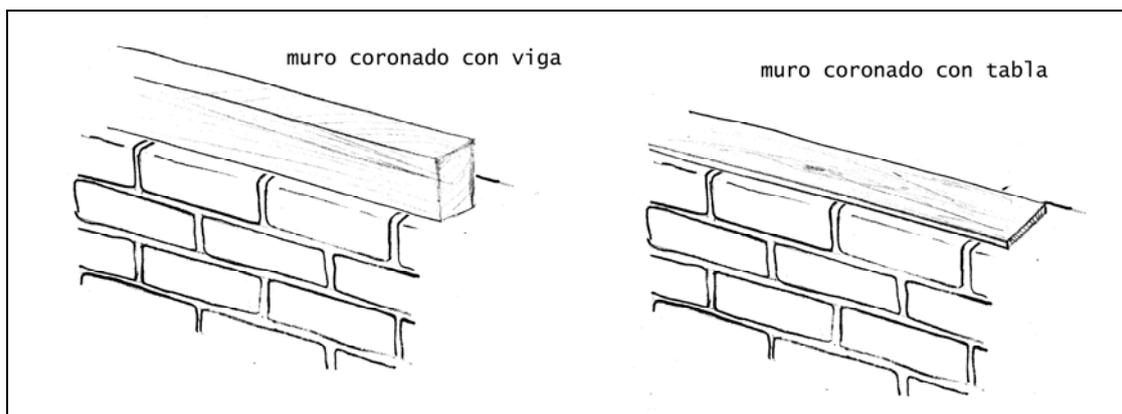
detalle de coronación del muro con durmiente: Fuente: De la Barraca Original a la Barraca Ideal.
